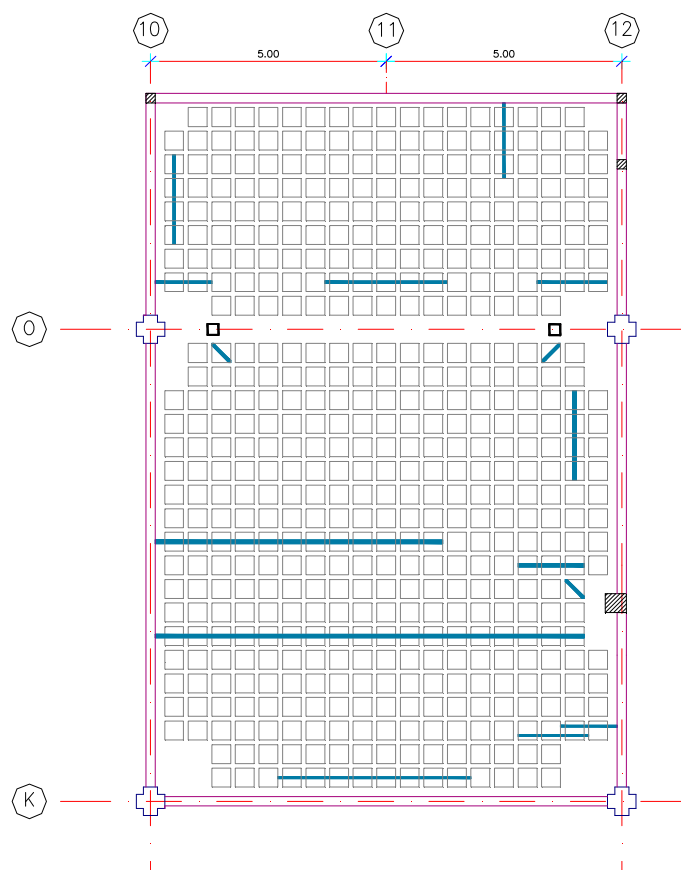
Reparación con Sikadur 52 en losa plana del Bloque Biblioteca
